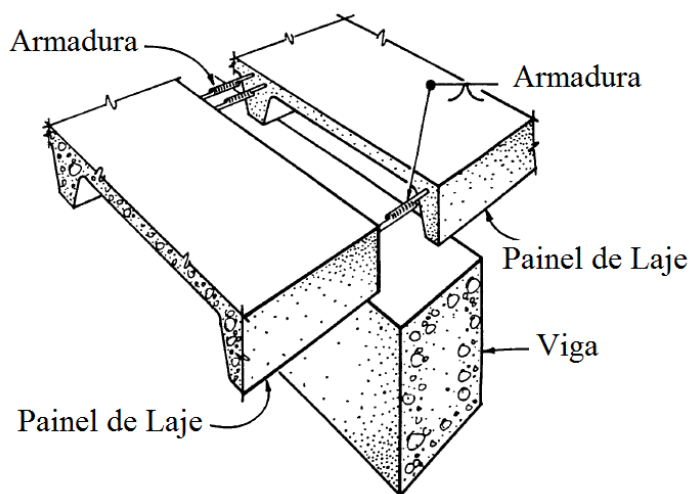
Conexão para continuidade de painéis de lajes pré-moldadas; BIRKELAND *et al.* (1966).
